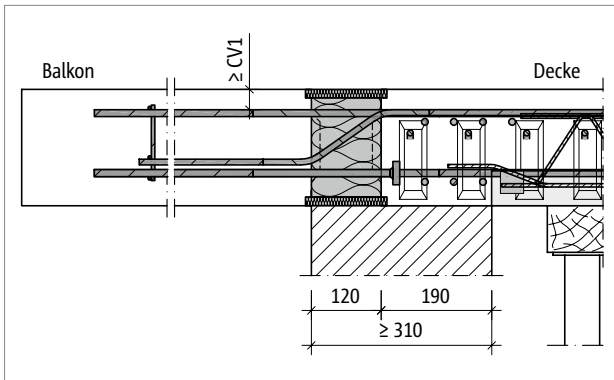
Schöck Isokorb® XT Typ CL: Halbfertigteilplatte mit Randunterstützung mit wärmedämmendem Mauerwerk (Schnitt XT Typ CL-L-CV1, Ansicht XT Typ CL-R-CV2)
